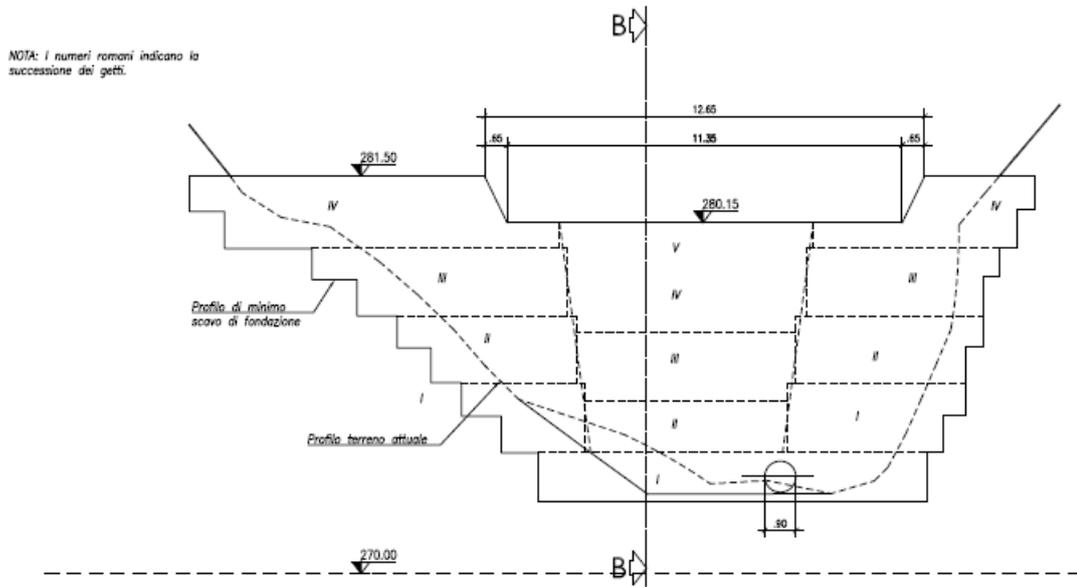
Sbarramento SA02 Percussente – Prospetto di progetto
